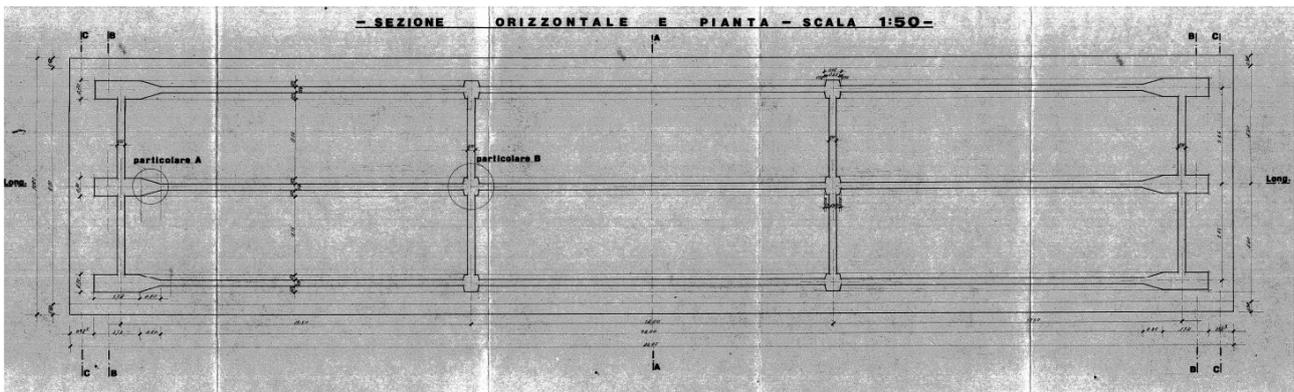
Impalcato a 3 travi in CAP – Pianta
